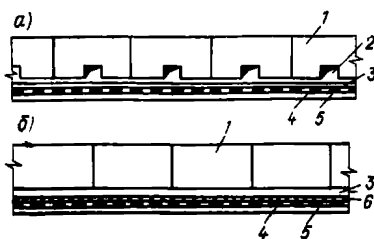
Конструктивные схемы фундаментов с применением выравнивающих средств защиты здания
